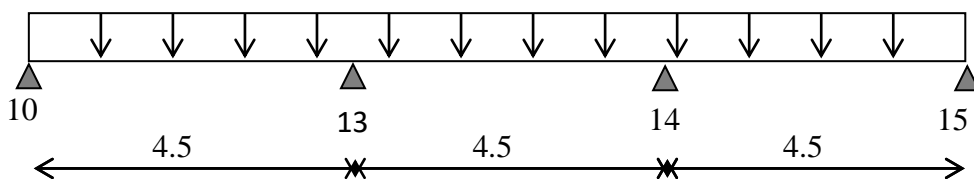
Schéma des poutrelles de plancher inaccessible de bloc C
